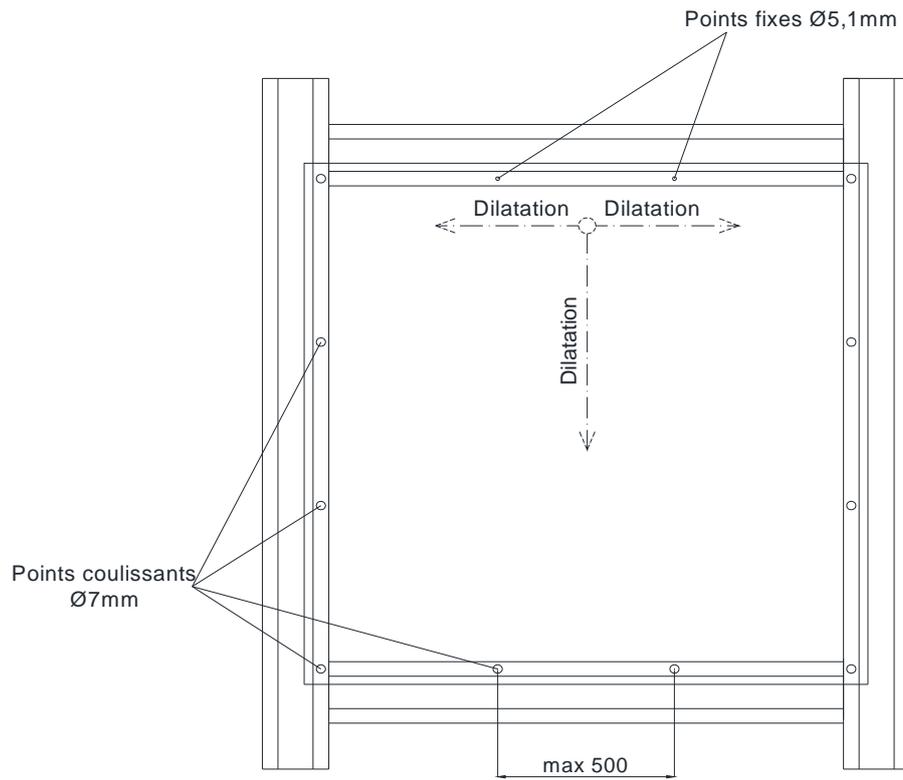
Disposition des fixations sur les panneaux avec traverse intermédiaire
